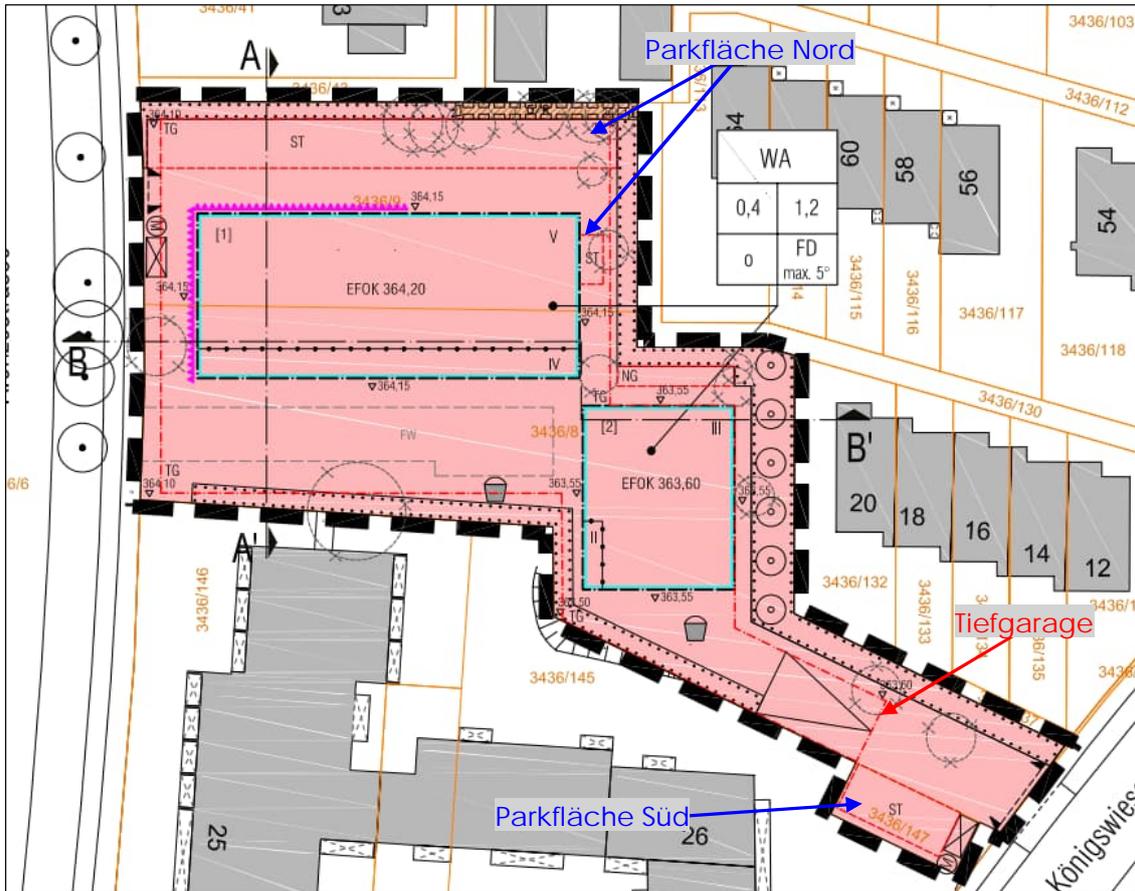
Übersichtslageplan mit Kennzeichnung der Parkflächen
